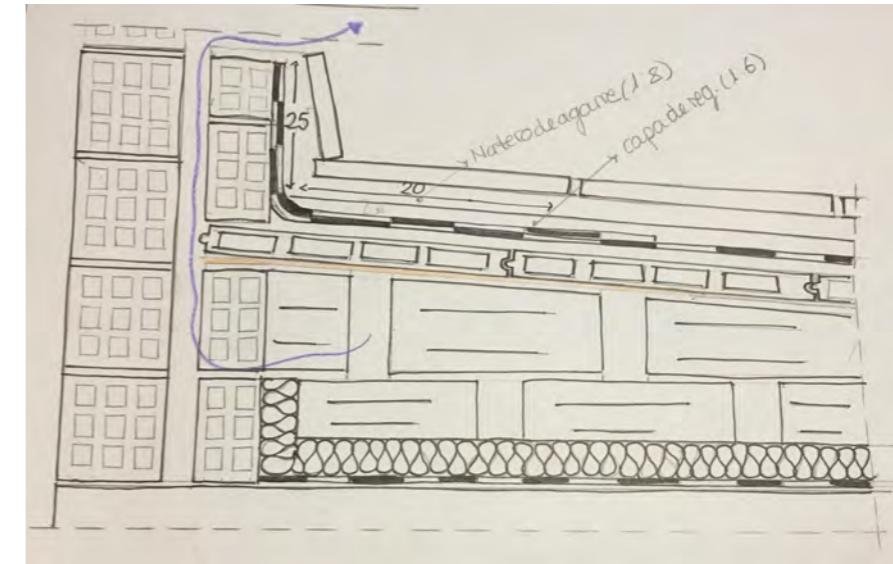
Detalle tipo Cubierta plana transitable. Dibujo propio.
